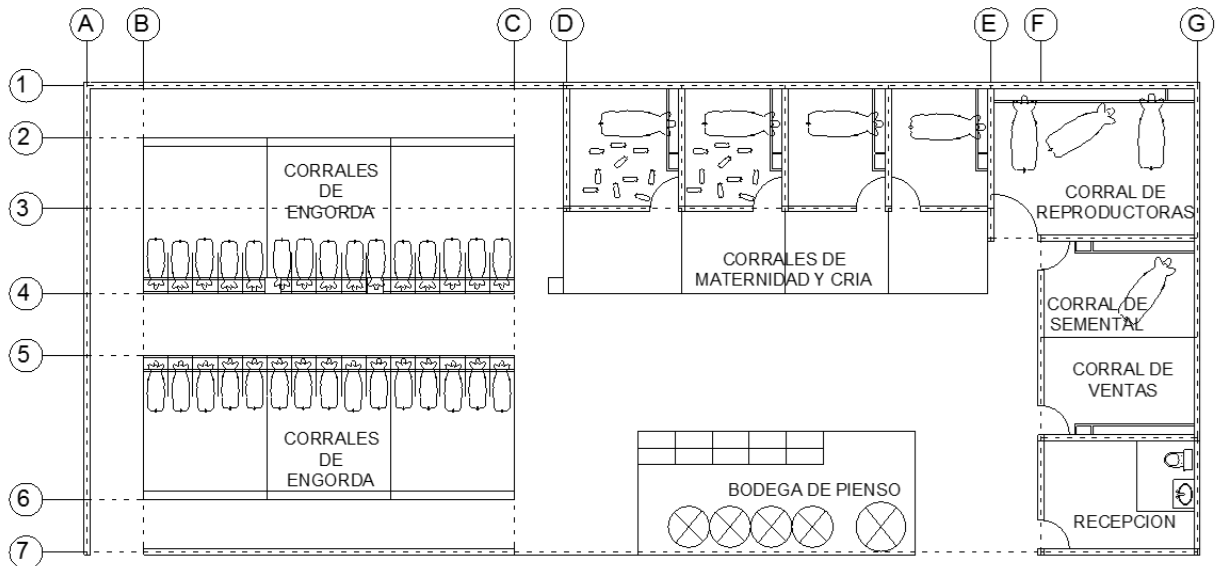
Vista en planta de las instalaciones de la vivienda.
